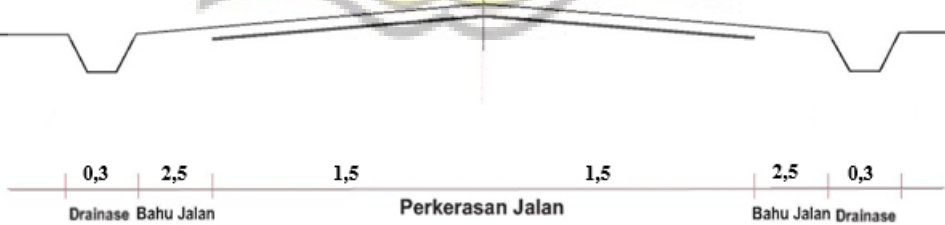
Sketsa Potongan Jalan Sukun
